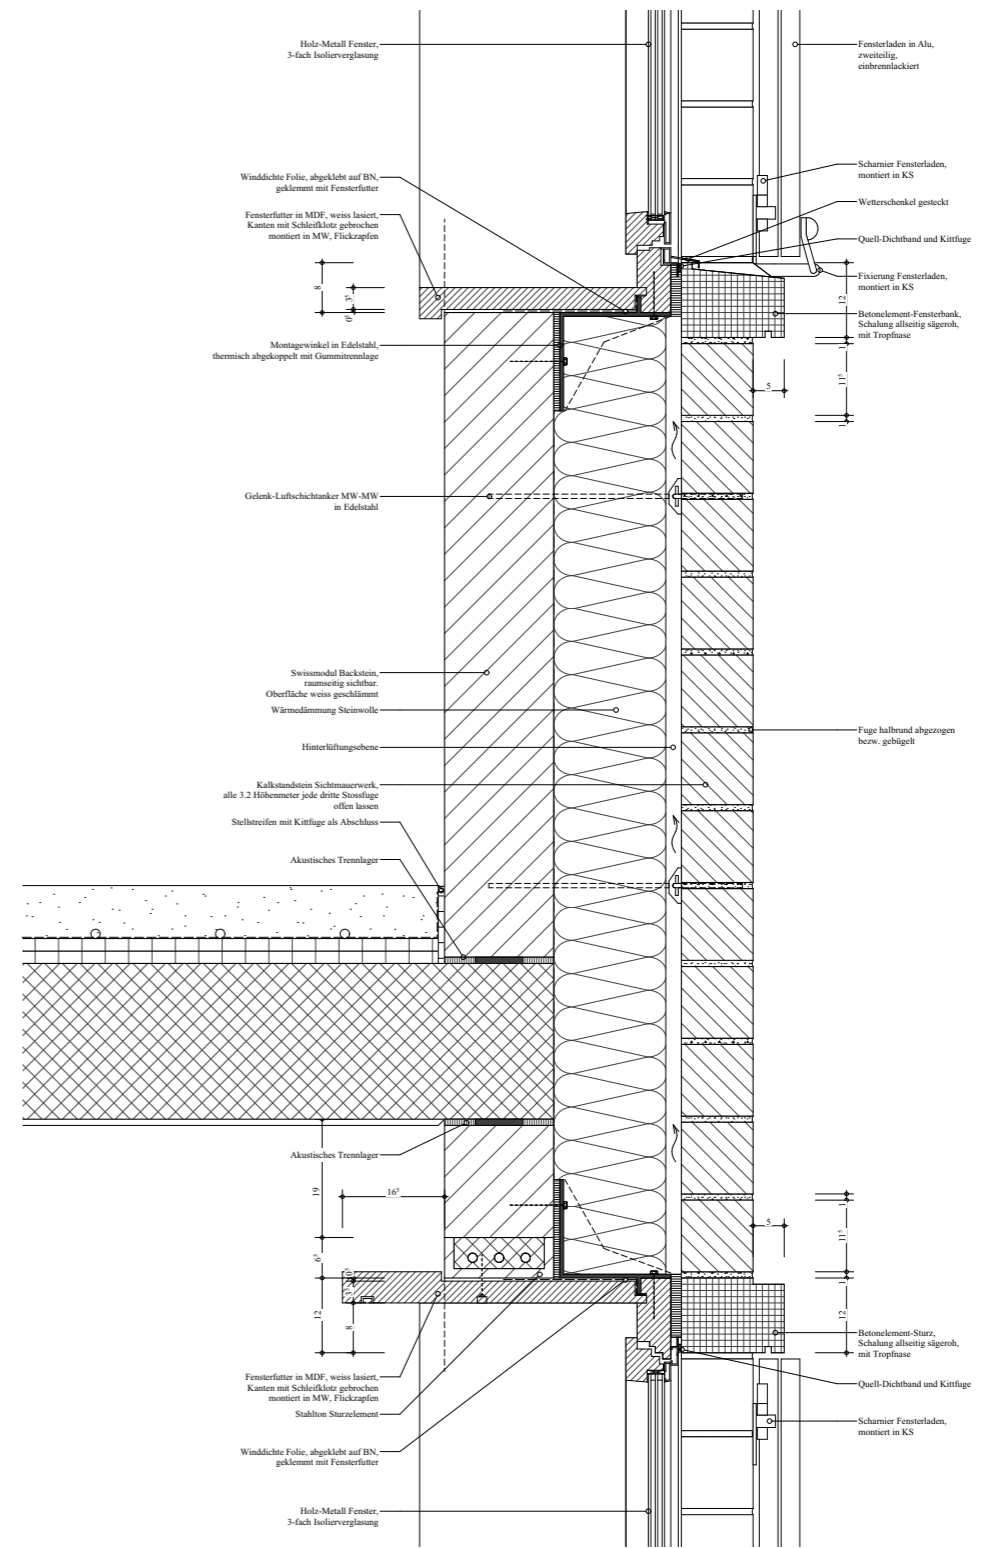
Konstruktive Vertiefung Ostfassade Neubau (Sturz- und Brüstungsdetail)
